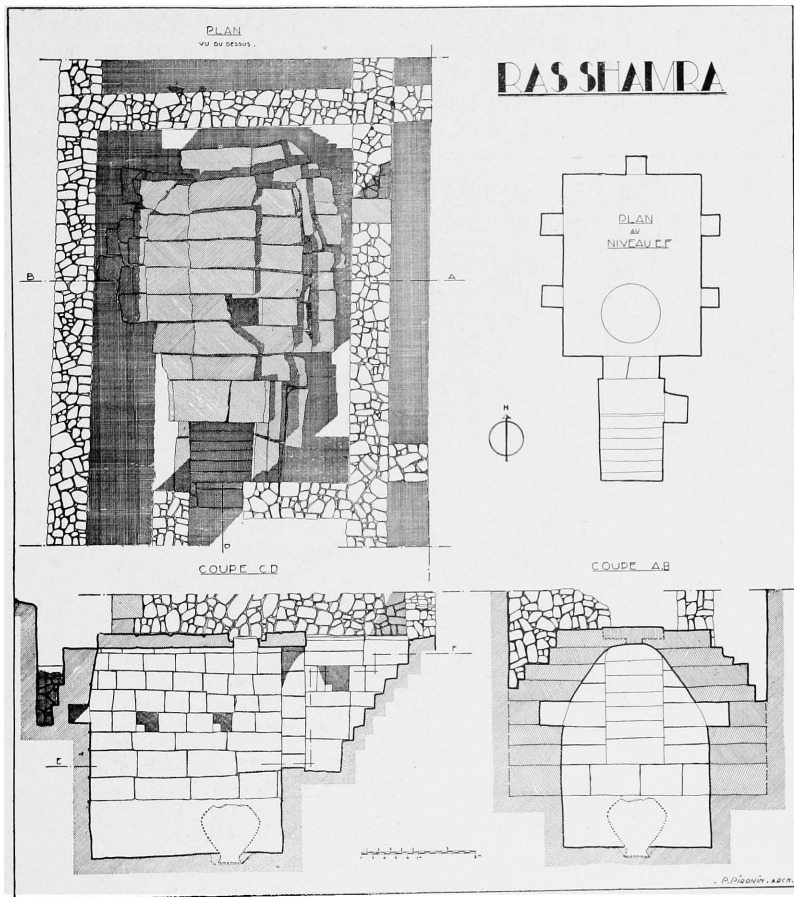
Plan et coupes du caveau VIII (p. 77).
